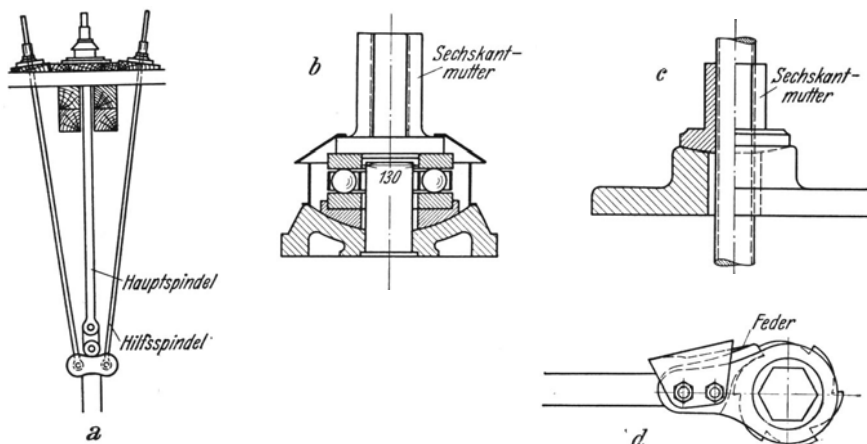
Aufhängung des Druckkastens. a) Absenkspindel, b) Spindelmutter mit Kugellager, c) Spindelmutter mit Gleitlager, d) Ratsche zur Bedienung der Muttern. [a), b) nach G. Hetzel; c), d) nach O. Franzius.]
